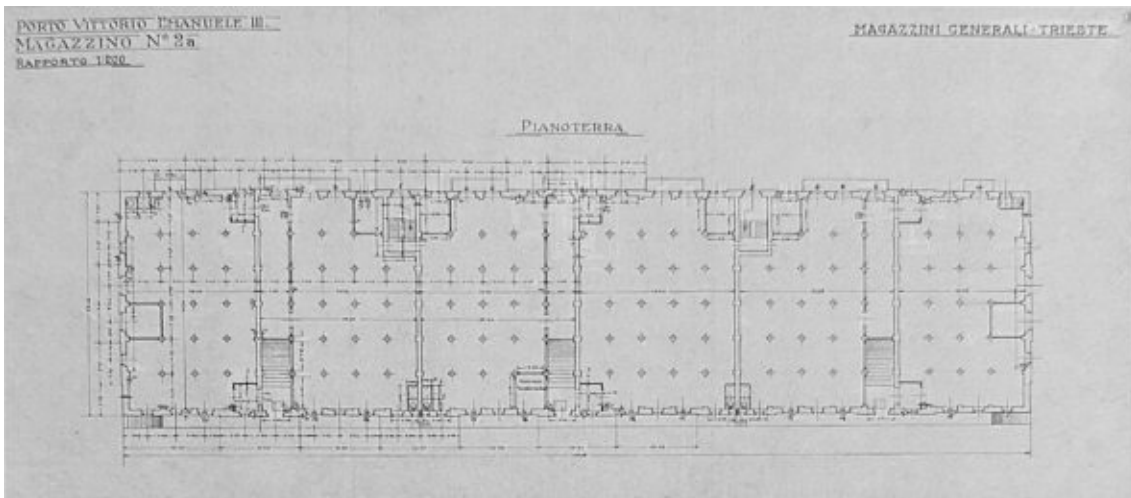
Lagerhaus 2a, Grundriss.
